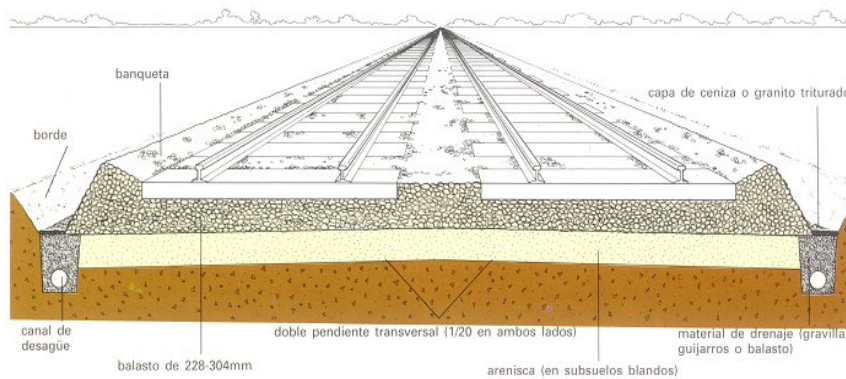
Drenaje en vía férrea⁹⁰
